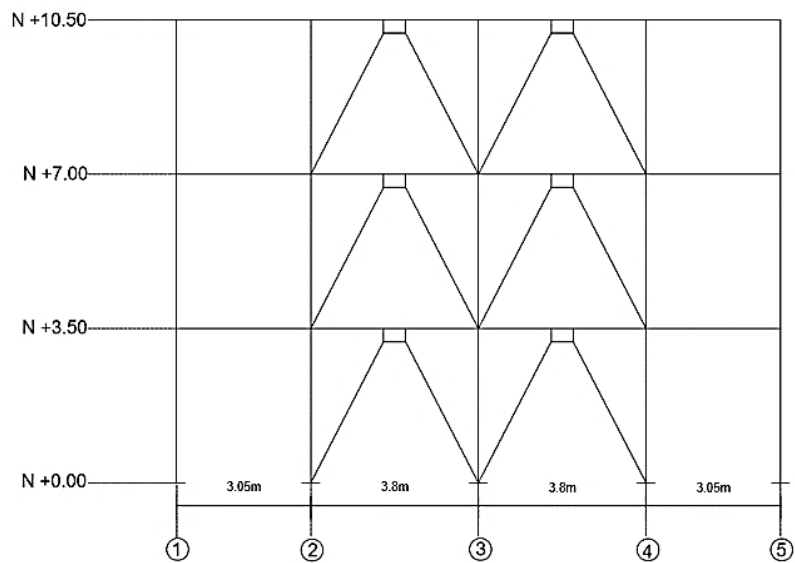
Vista en Elevación de la Edificación con Disipadores ADAS
